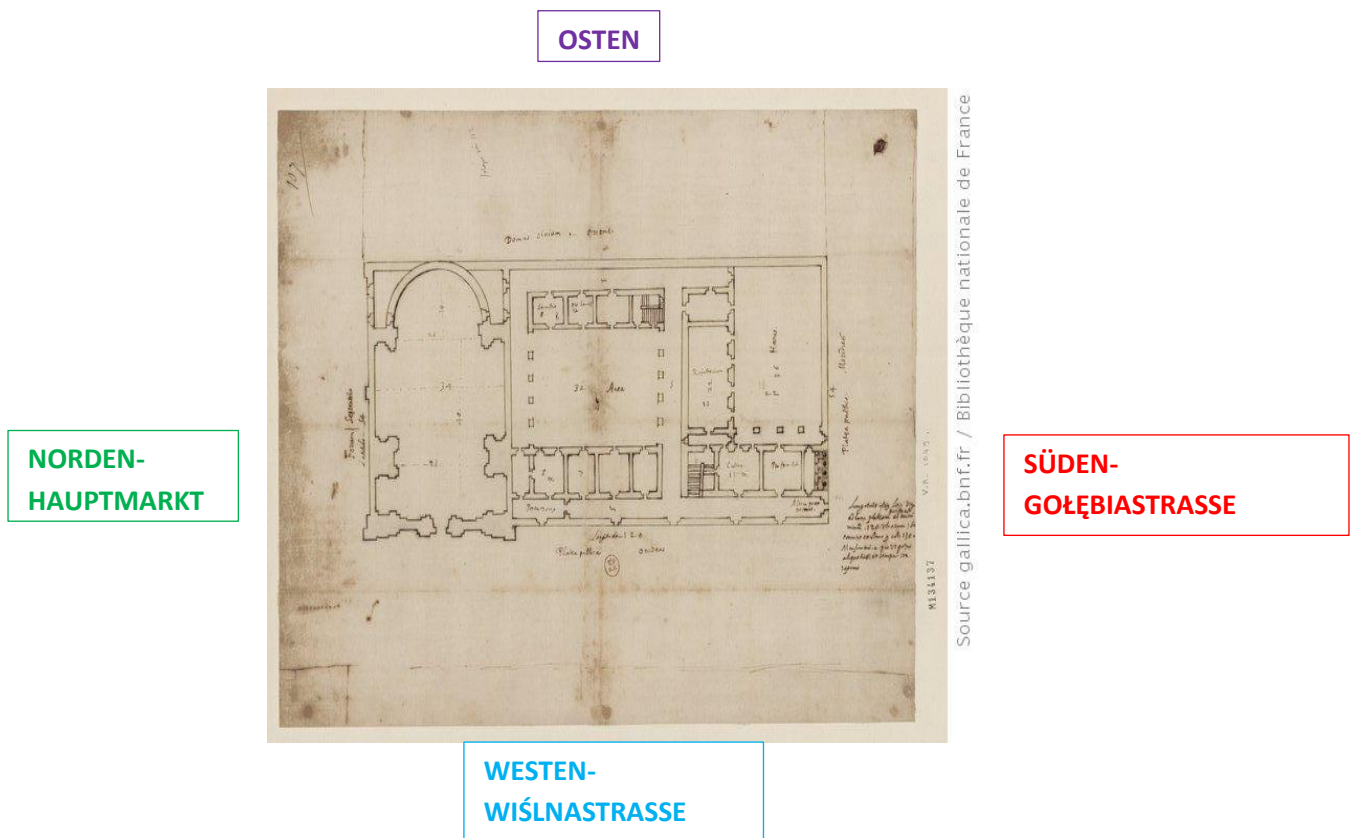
Plan Nr. V. R. 1049, Projekt der Kirche und des Klosters in der Wiślnastraße, Braccio, 1593.
